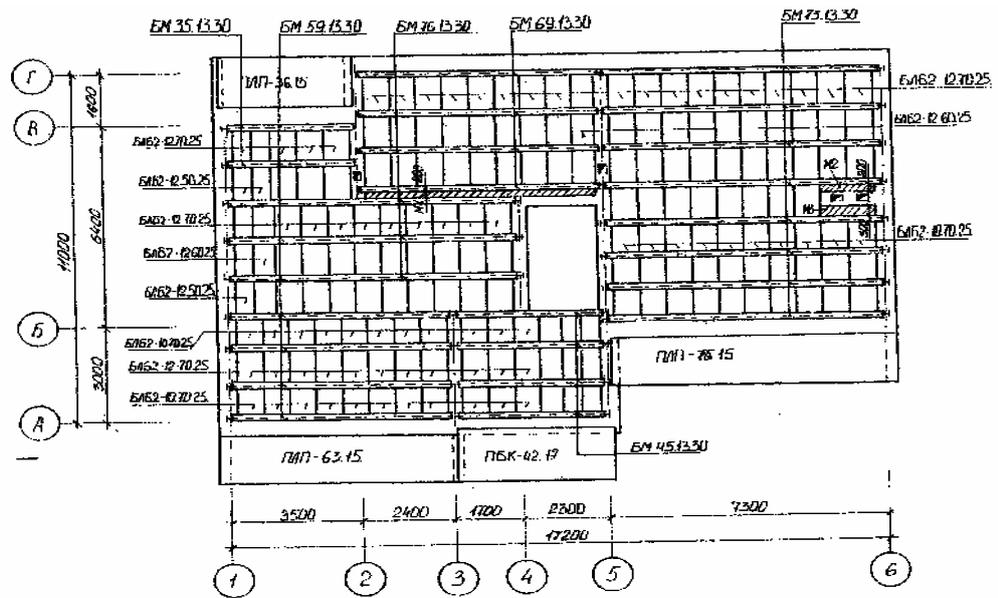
Пример оформления плана перекрытий из мелкоразмерных элементов
